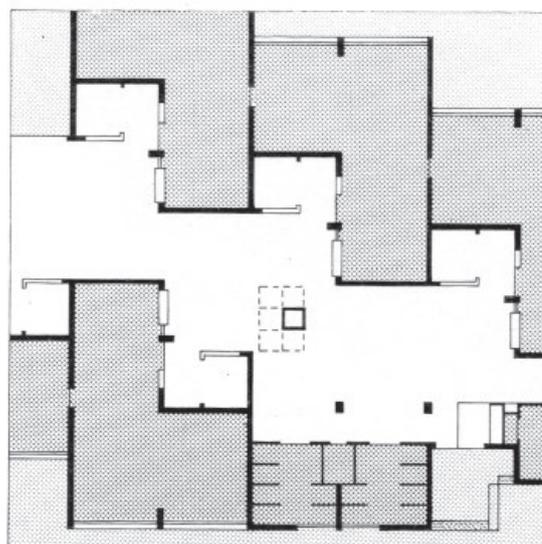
Planta mostrando a posição do hall de apresentações e do conjunto de blocos de madeira.
